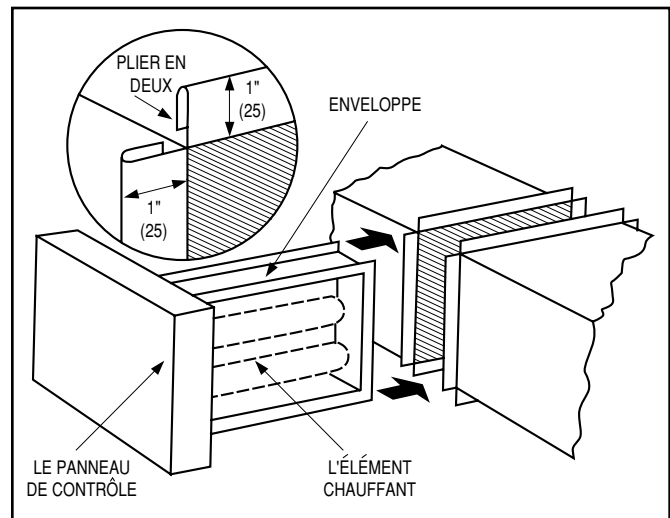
CHAUFFE-CONDUIT À BRIDES
